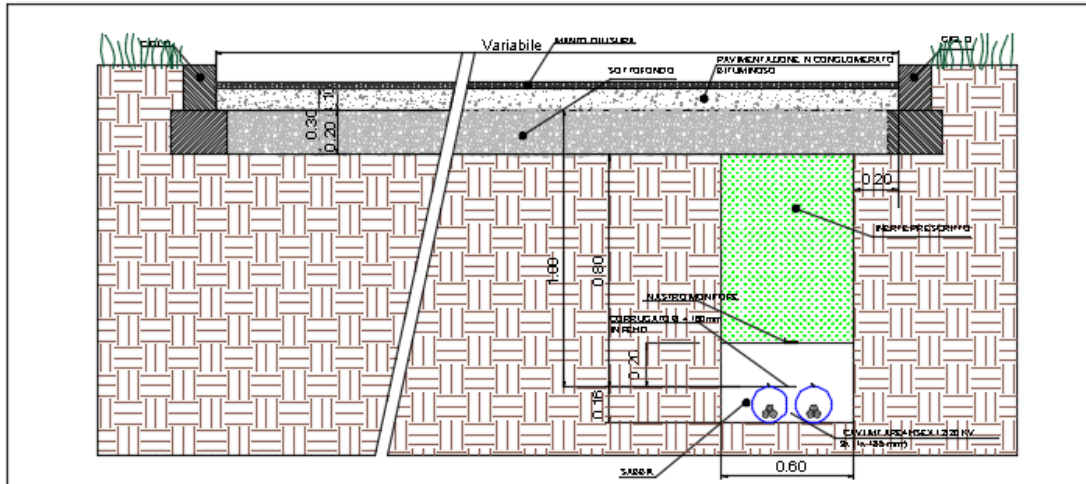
Sezione tipo cavidotto MT di connessione – Su strada asfaltata
